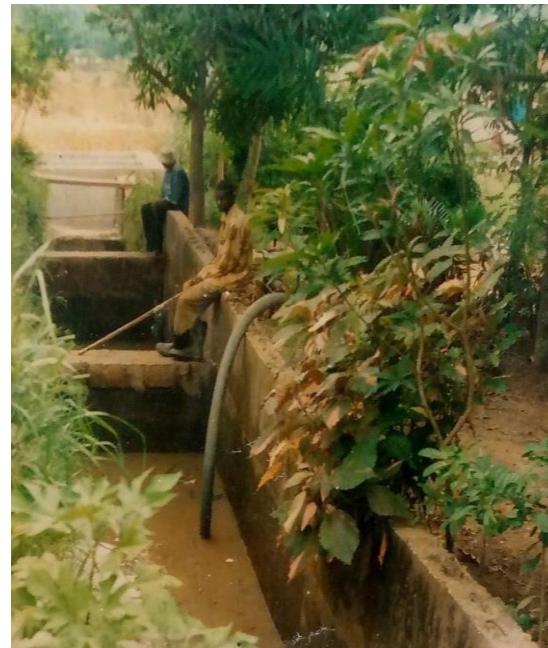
et 16 : Collecteur d'eau semblable à la photo 2, même système de protection d'ouvrage.
